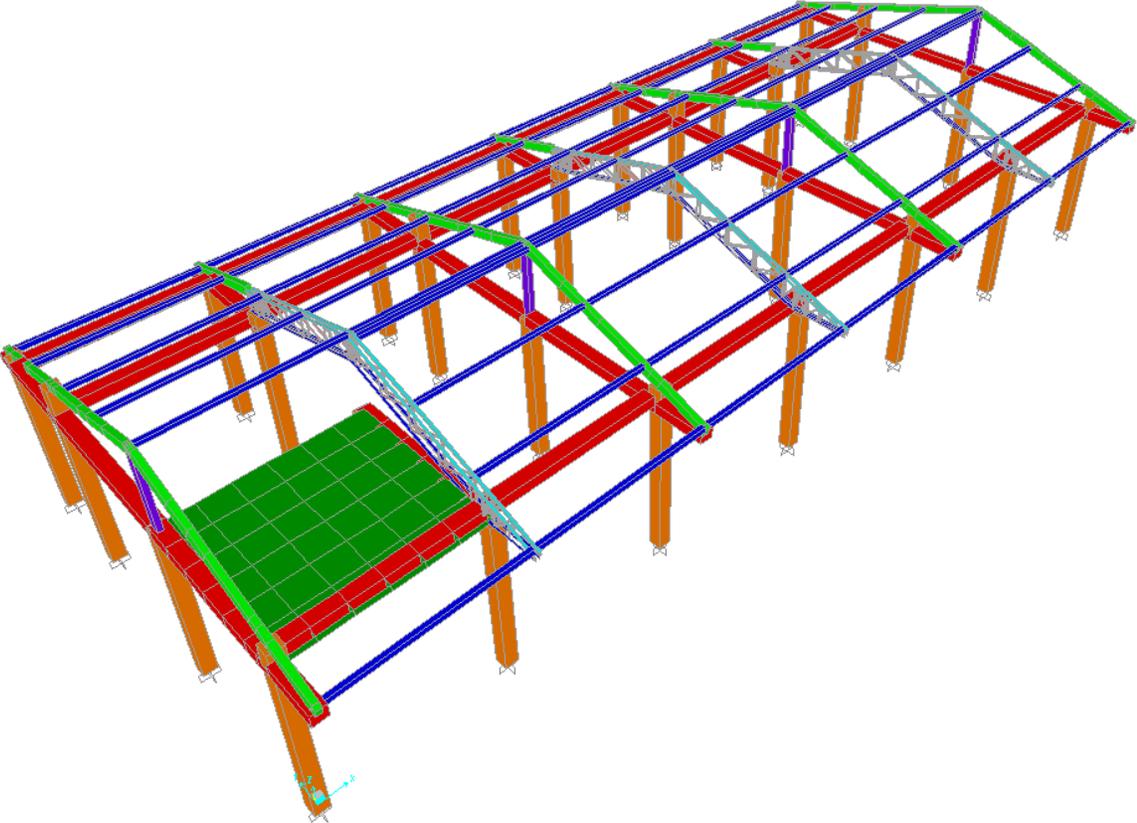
Geometría elementos estructurales C.E.M. Campanero
